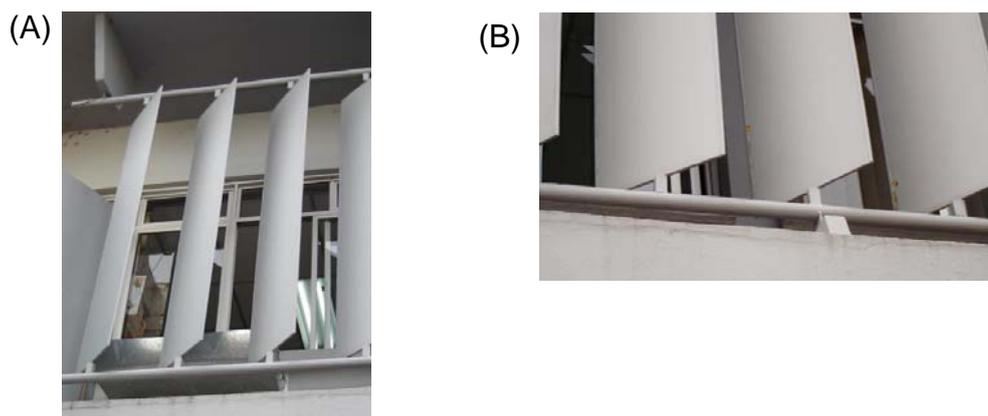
(A) afastamento entre painéis permite adequada ventilação (B) detalhe da estrutura metálica e dos painéis
